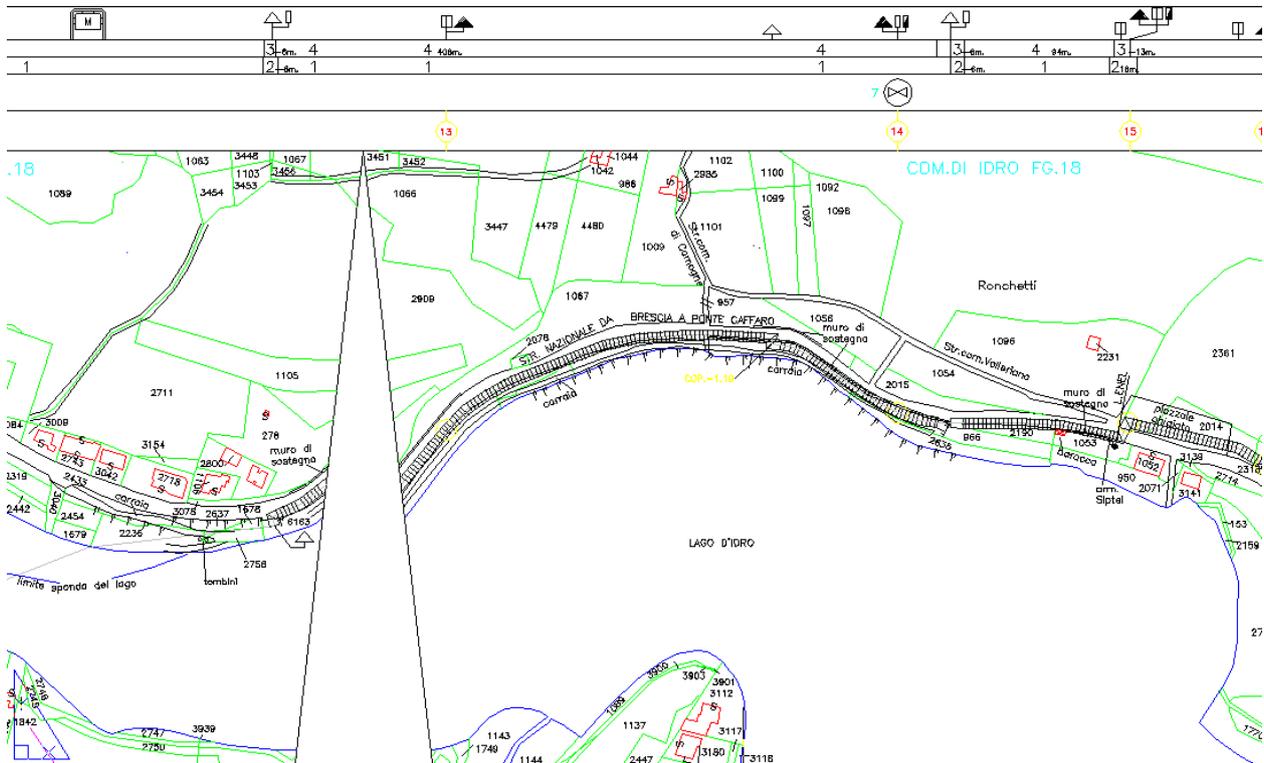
planimetria con individuazione metanodotto in via Trento, Comune di Idro ricevuta dall'ente gestore.
